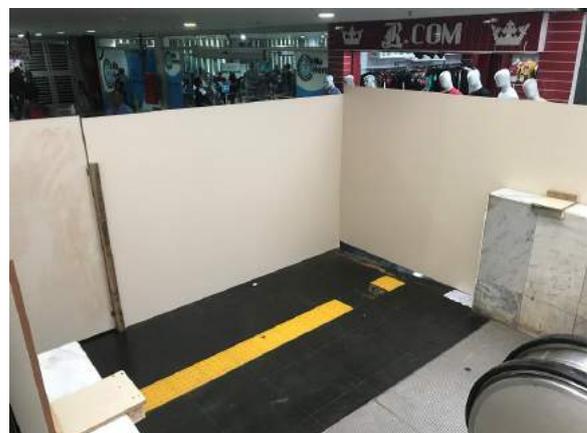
Detalhe de falha da sinalização podotátil próximo à escada;
